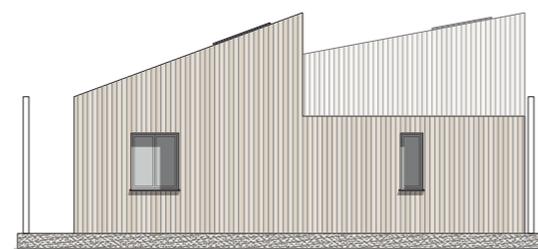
Prospetto modulo doppio con pareti aperte - variante 2.
